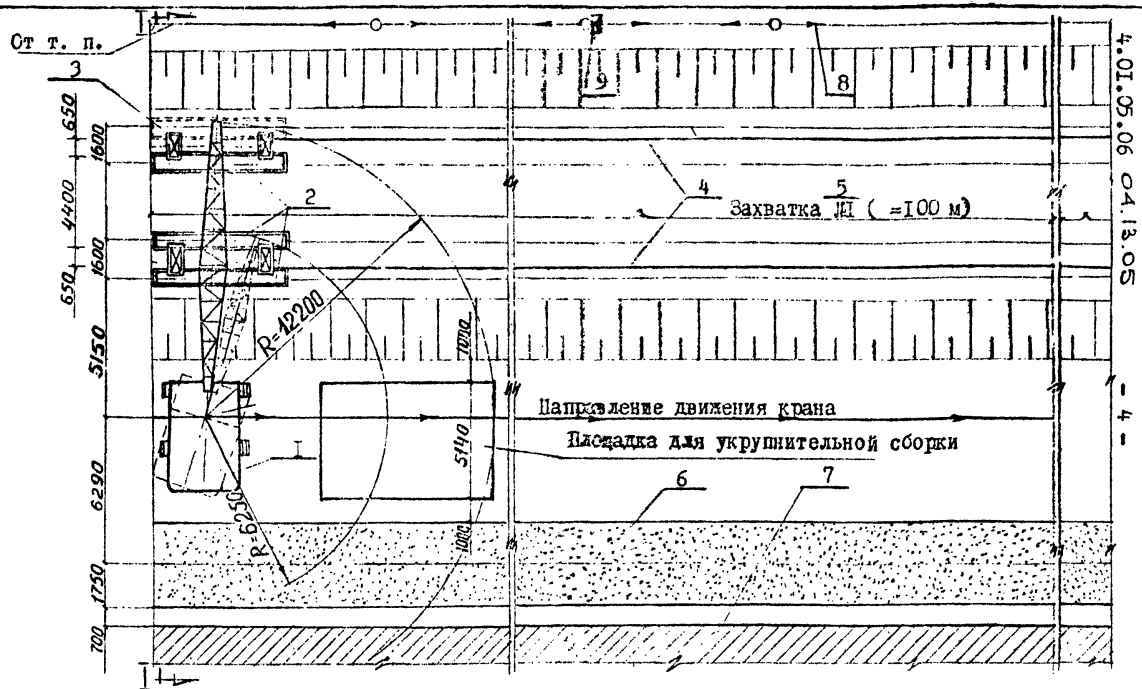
Схема организации работ по монтажу и демонтажу горизонтально-скользящей опалубки.
